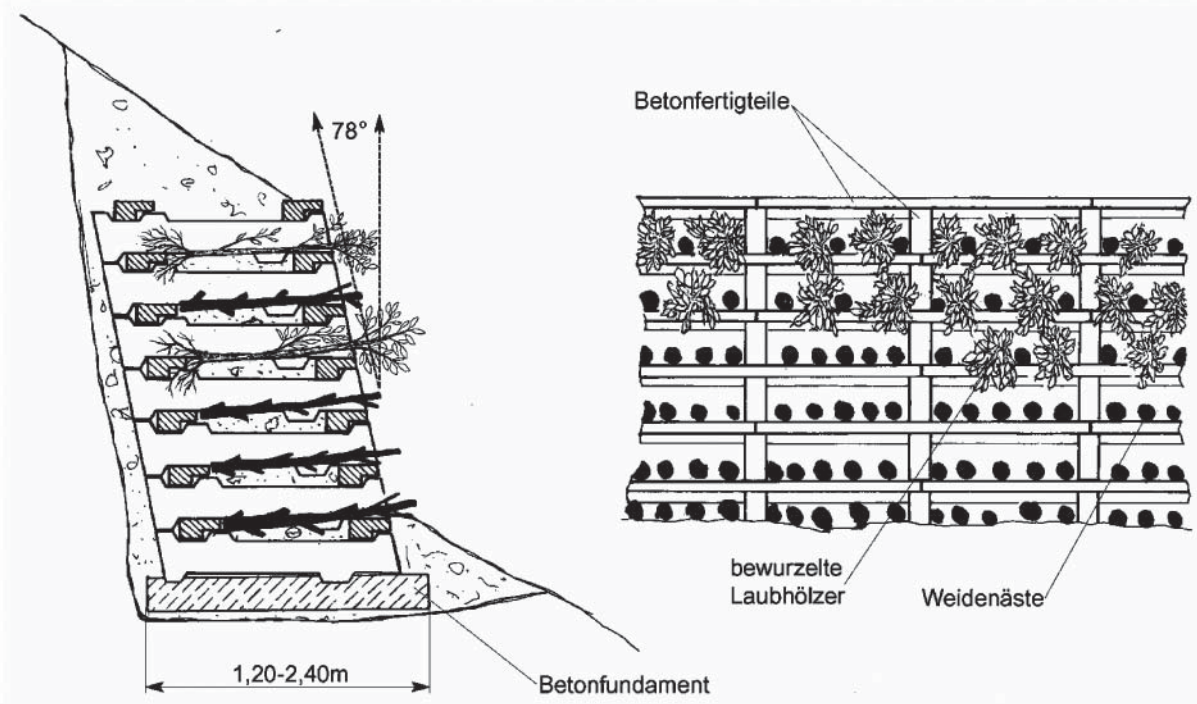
Schema einer bepflanzten Betonkrienerwand mit Gehölzeinlagen
